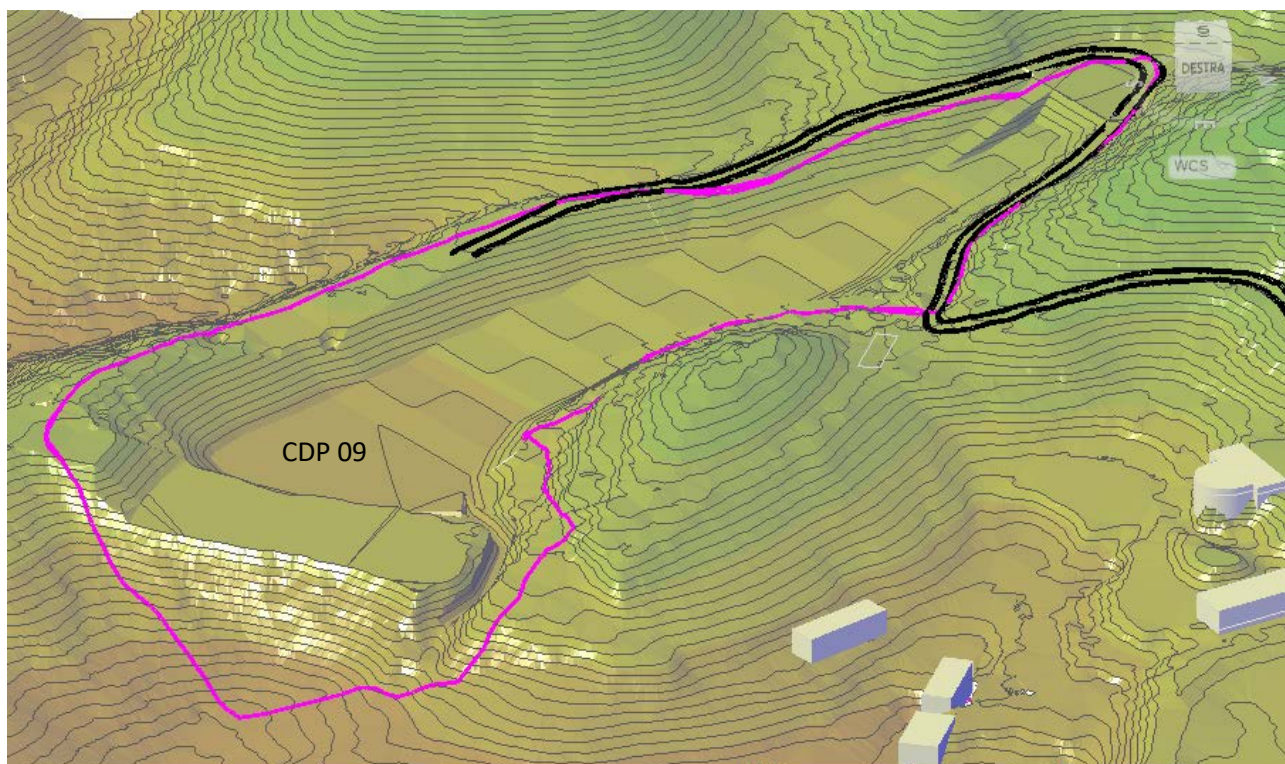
VISTA 3D DELLO STATO DI PROGETTO – FASE 1 Cdp MA9 (VISTA DA E)
